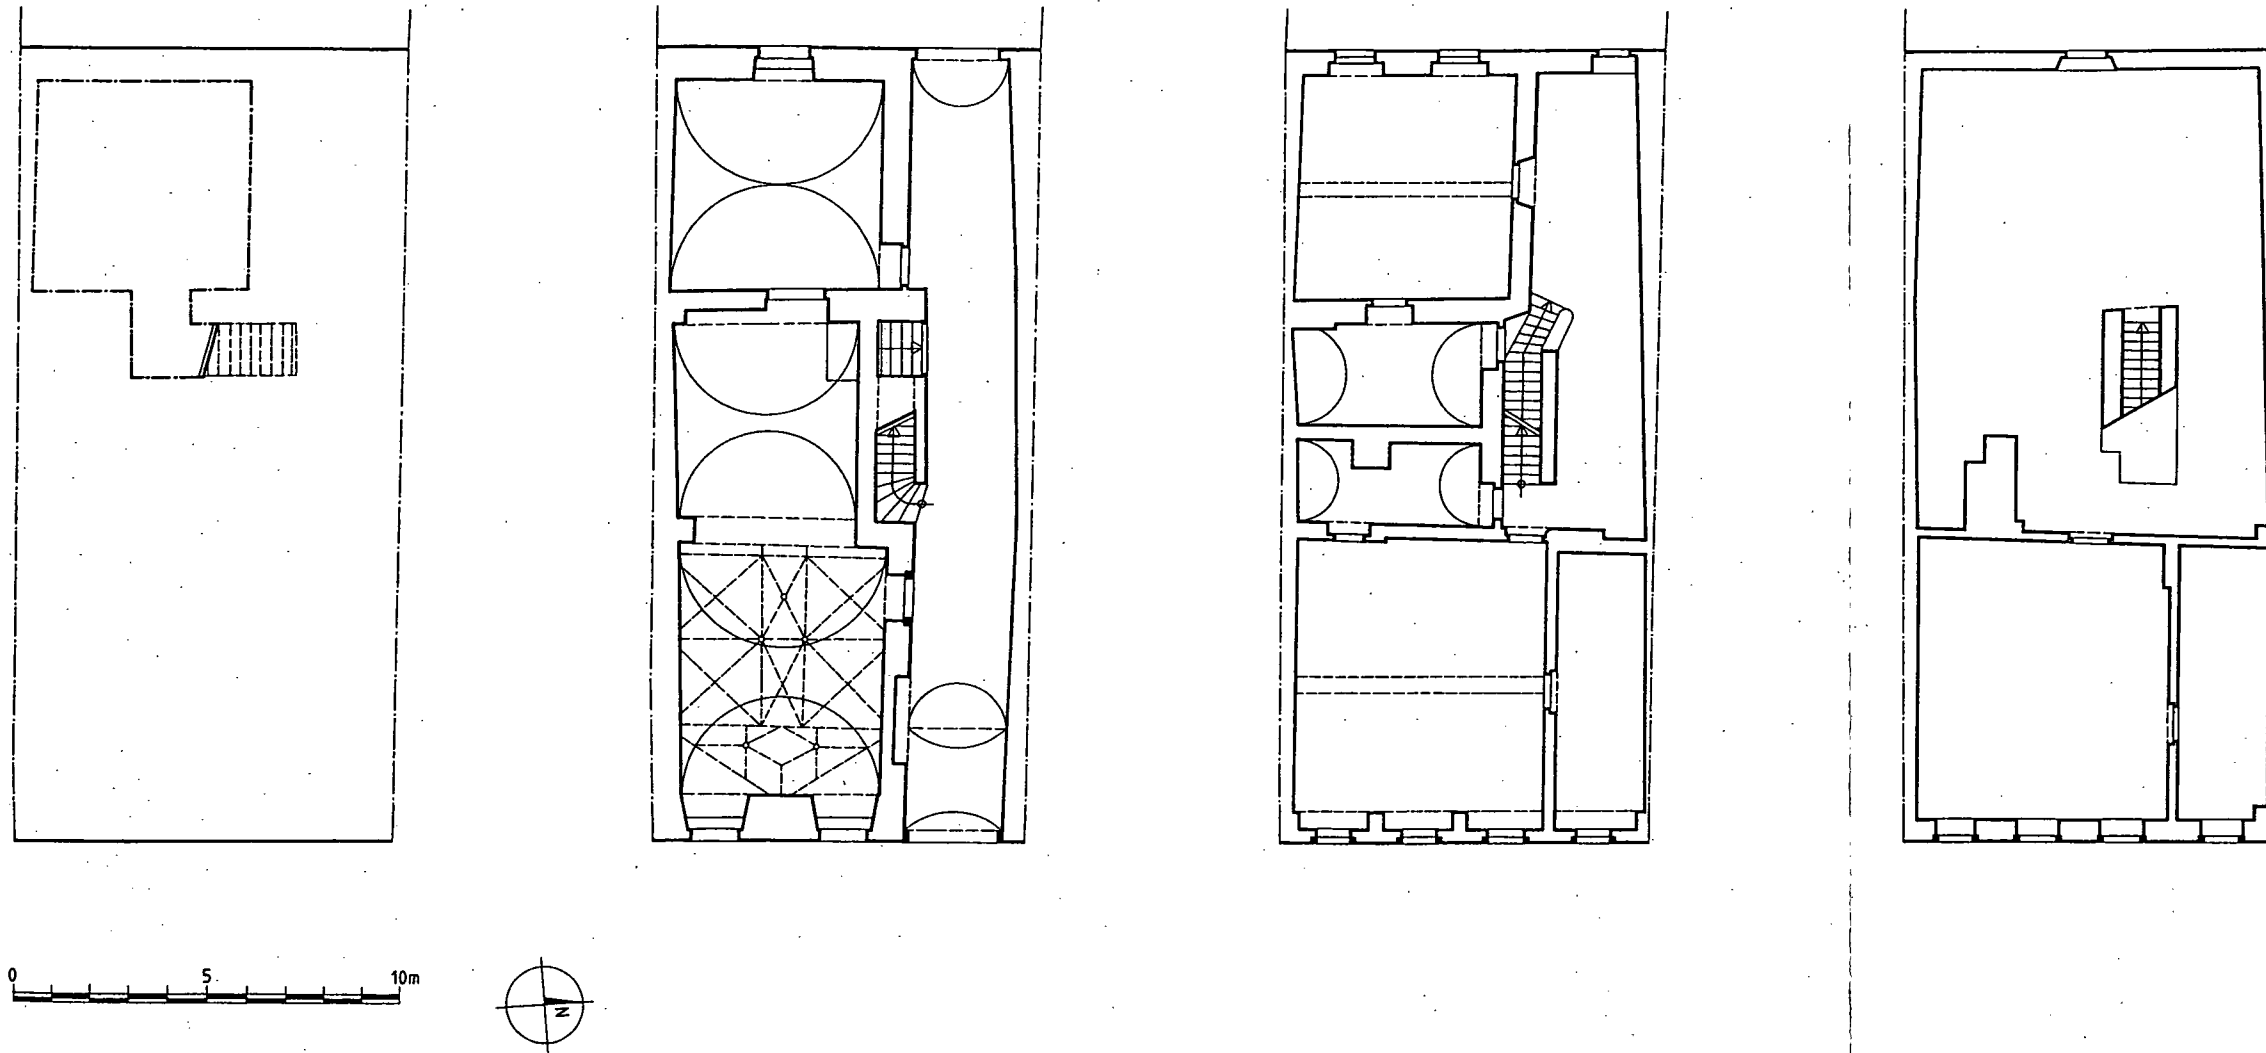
Stadtplatz 28 – Grundrisse Keller, Erdgeschoss, 1. und 2. Obergeschoss (1:200).
